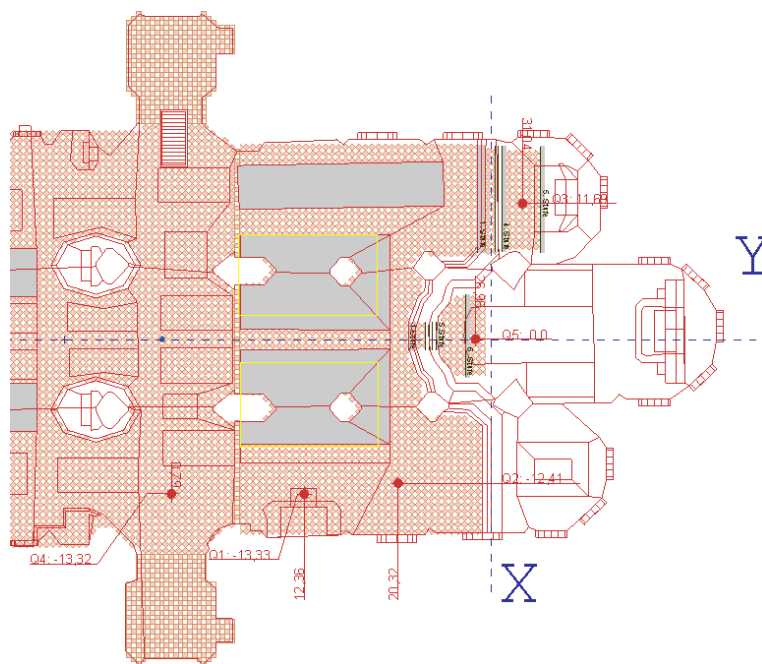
Grundriss Stephansdom, Quellpunkte
